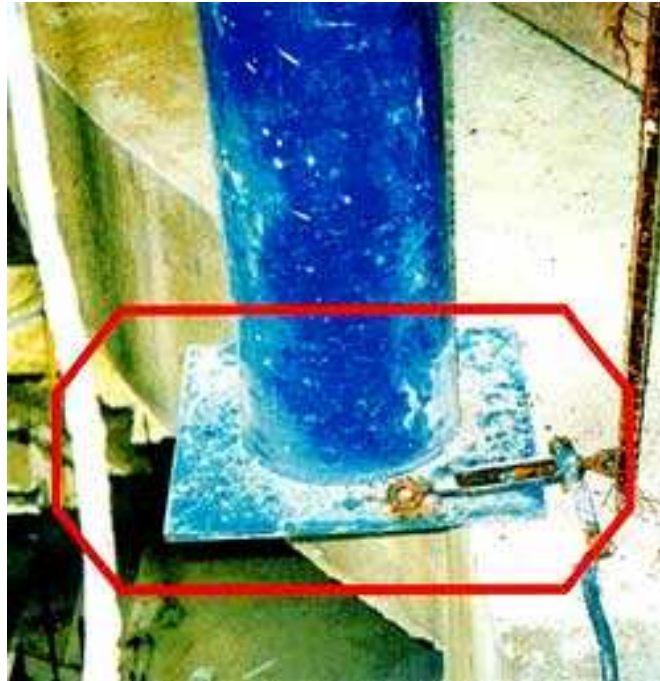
Incompatibilidade entre os projetos estruturais de concreto e metálico (PRAVIA & BETINELLI, 1998)
